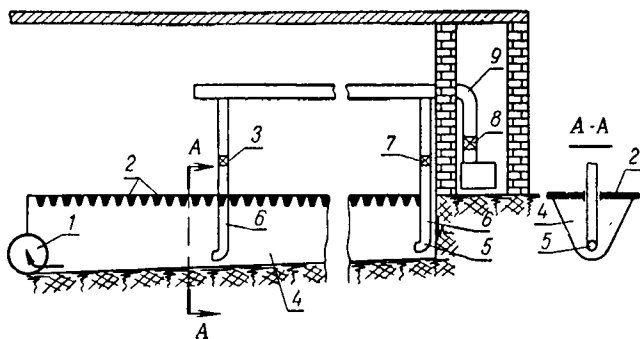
Схема гидротранспортировки навоза в совхозе «Белая дача»: 1—поперечный канал; 2—решетчатый пол; 3, 7, 8—задвижки; 4—канал; 5—форсунка; 6—трубопровод; 9—магистральный трубопровод.
